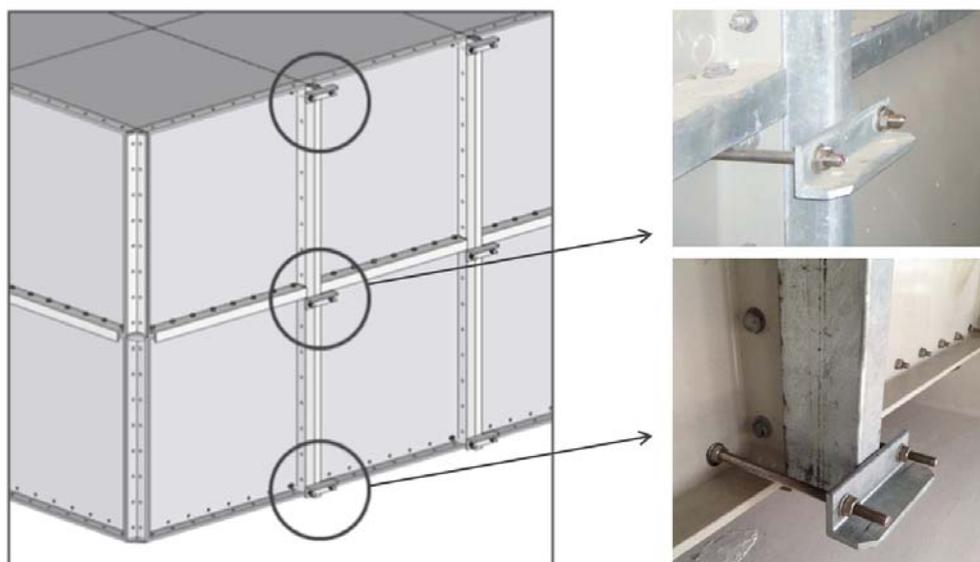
Braçadeiras verticais de reforço indicadas em “vermelho” na figura
